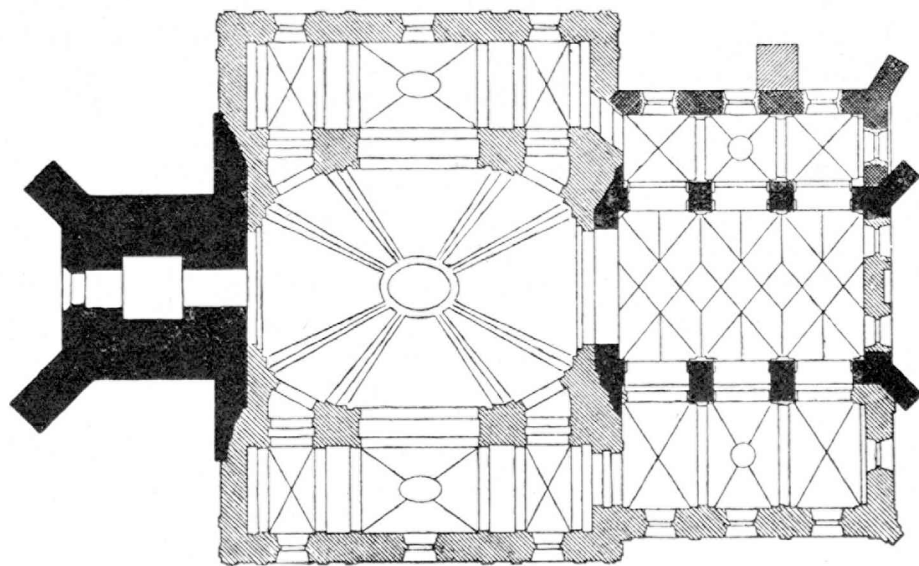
Plan Kolegiaty w Klimontowie. 1:400. Rys. 18. Plan kościoła na Bielanych p. Warszawą. 1:400.
